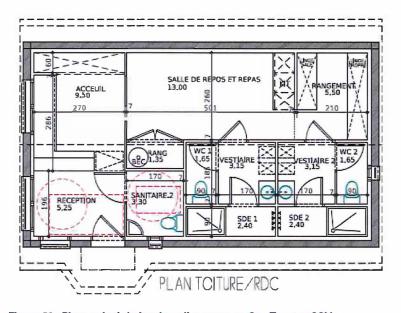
Plan projeté du local gardien, source : Cap Terre et CCV
